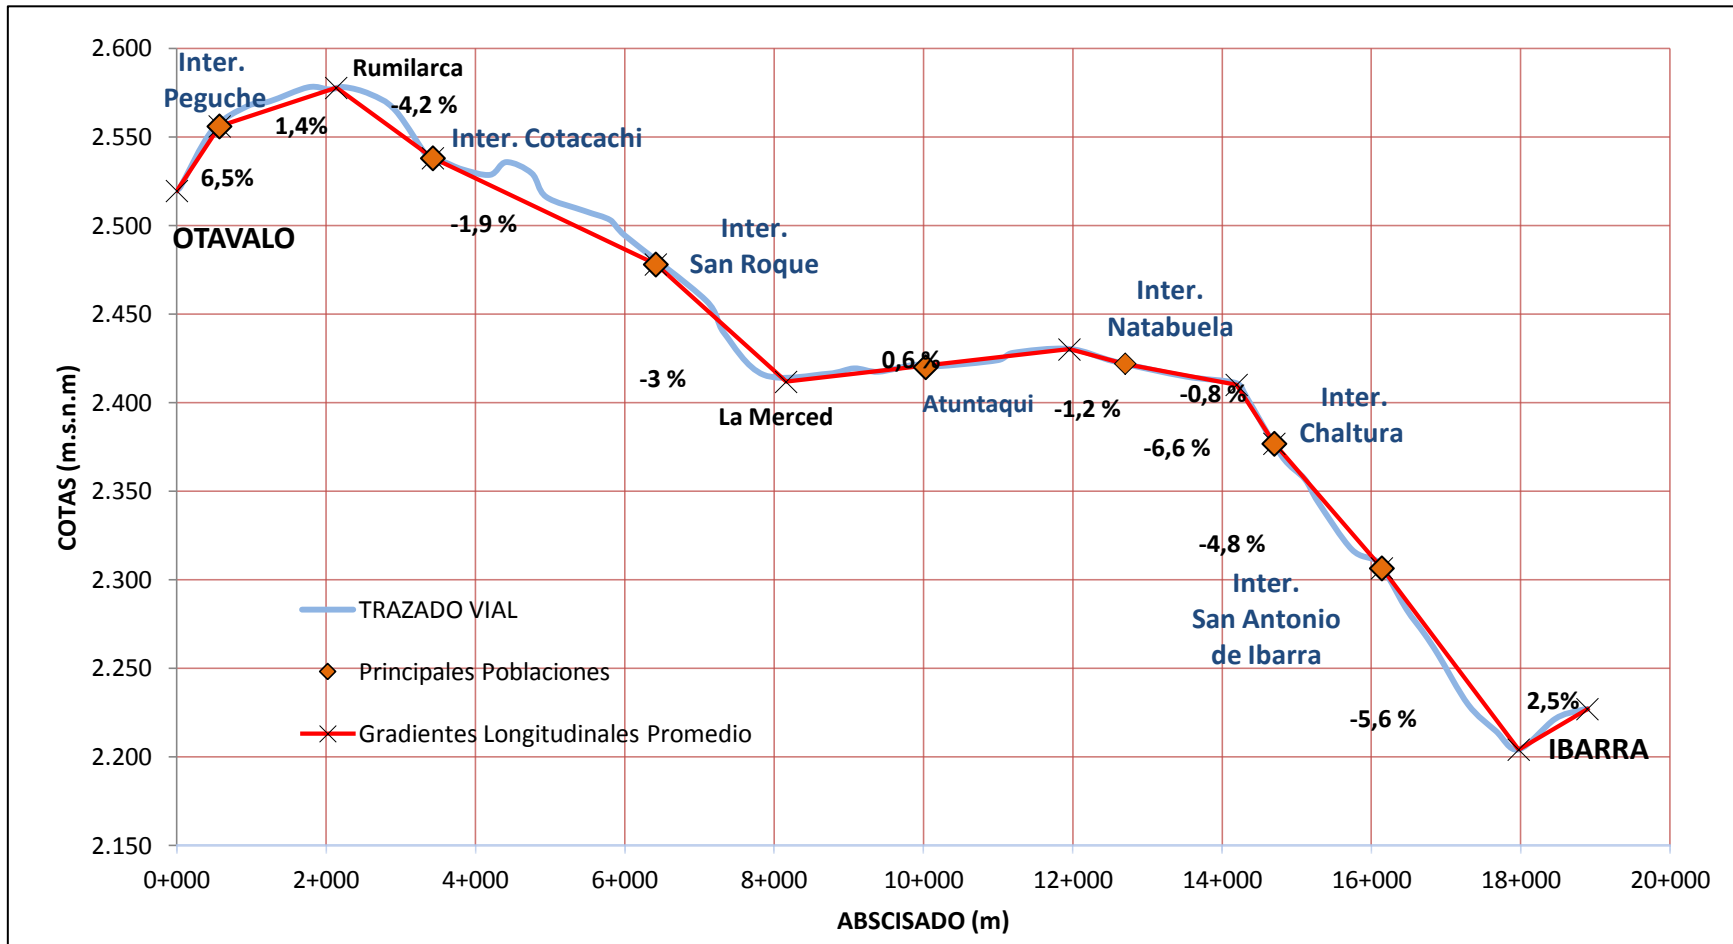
Trazado Vial - Gradientes Longitudinales Promedio
